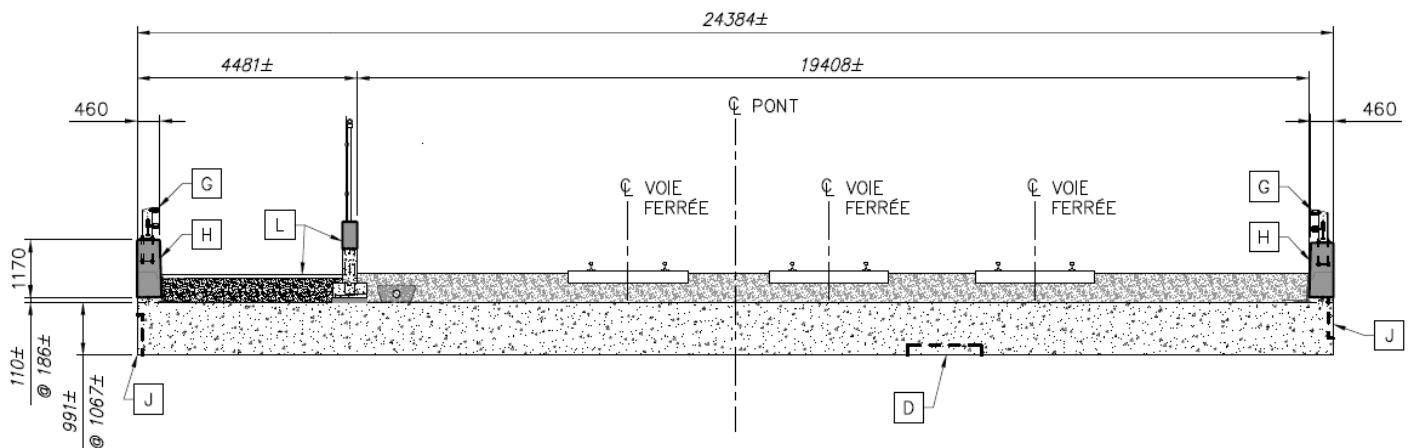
Extrait du plan d'ensemble – Coupe transversale du tablier
